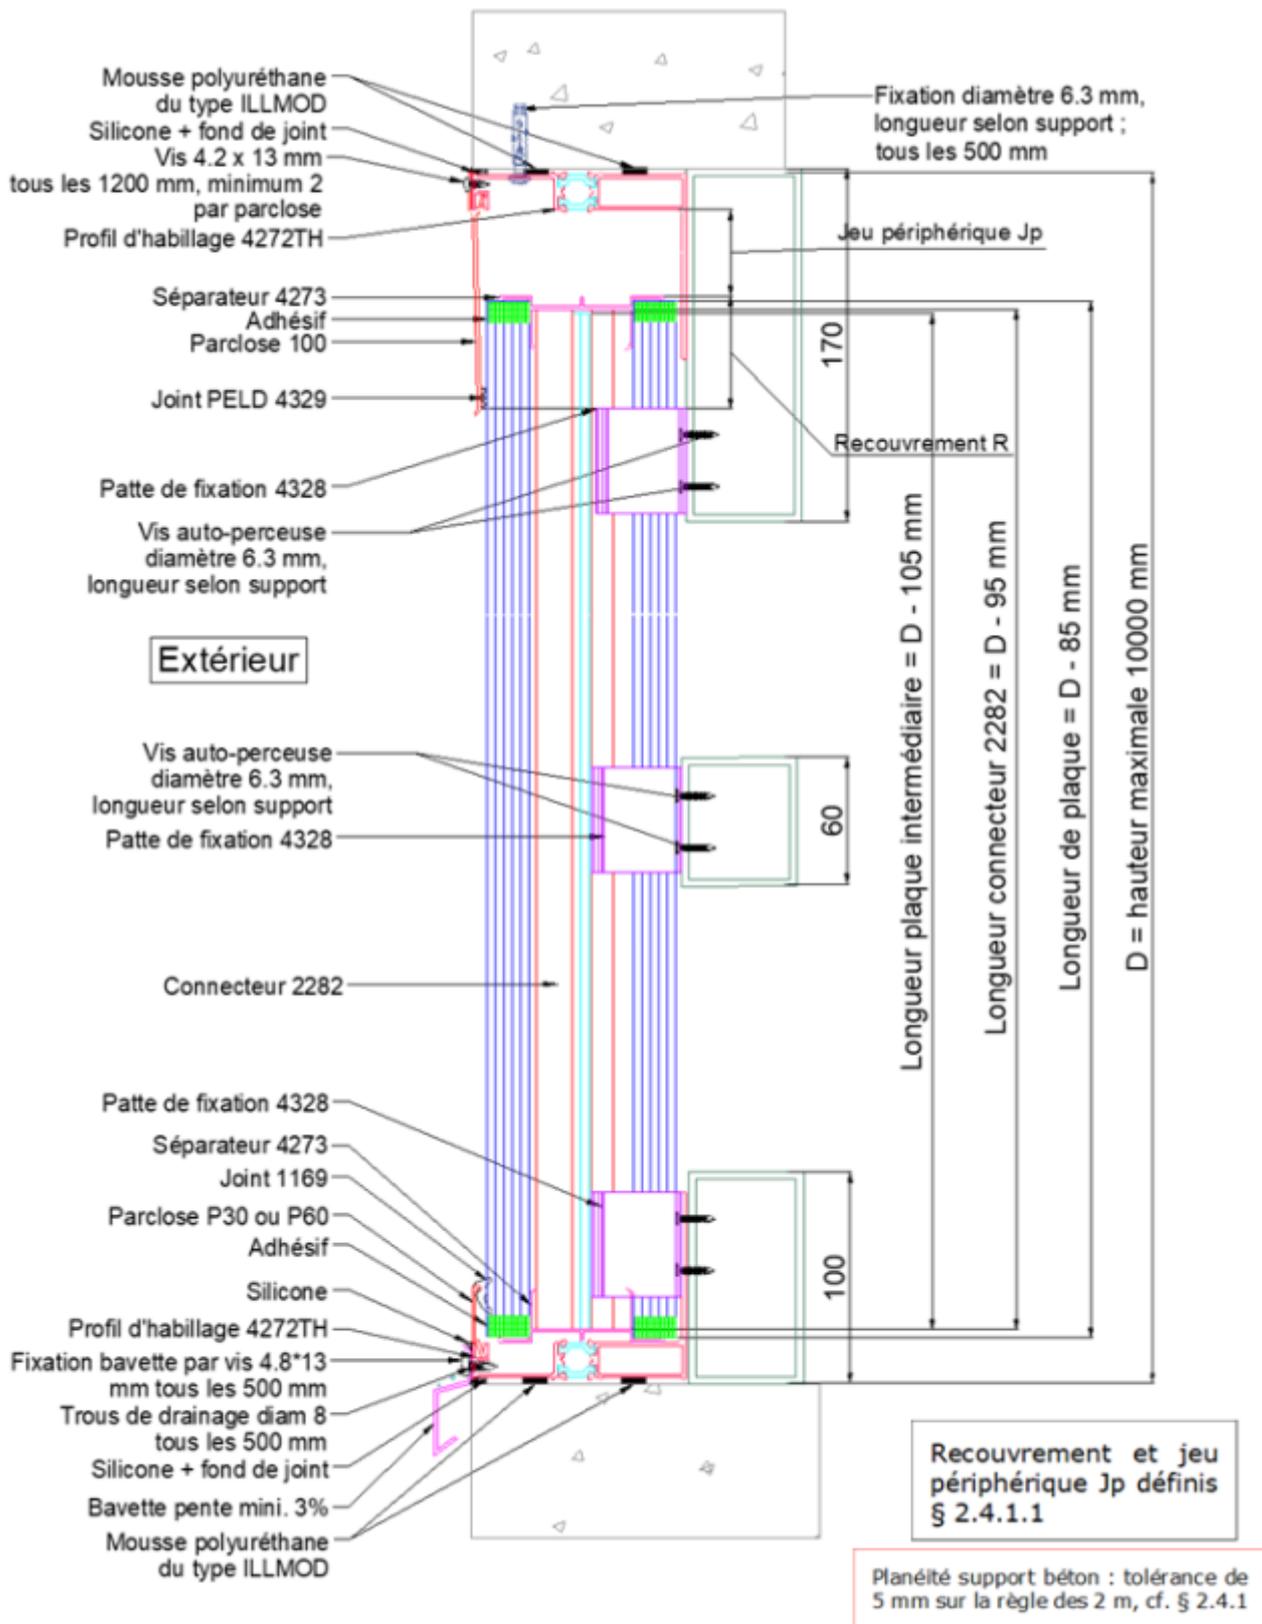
Pose en feuillure - Hauteurs de façade comprises entre 0 et 10 mètres
